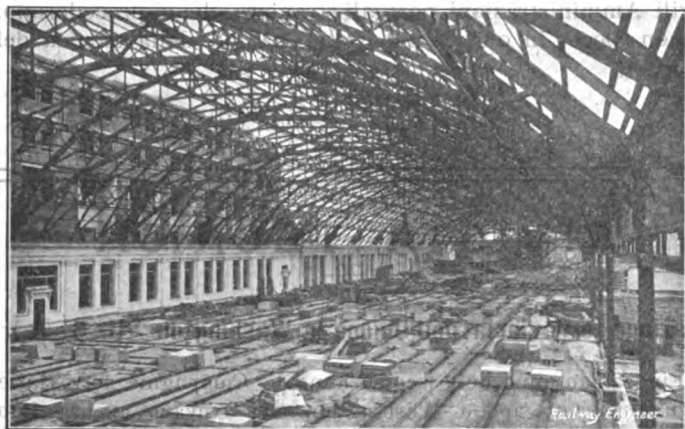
Stazione ferroviaria di Washington. - Vista della tettoia.
